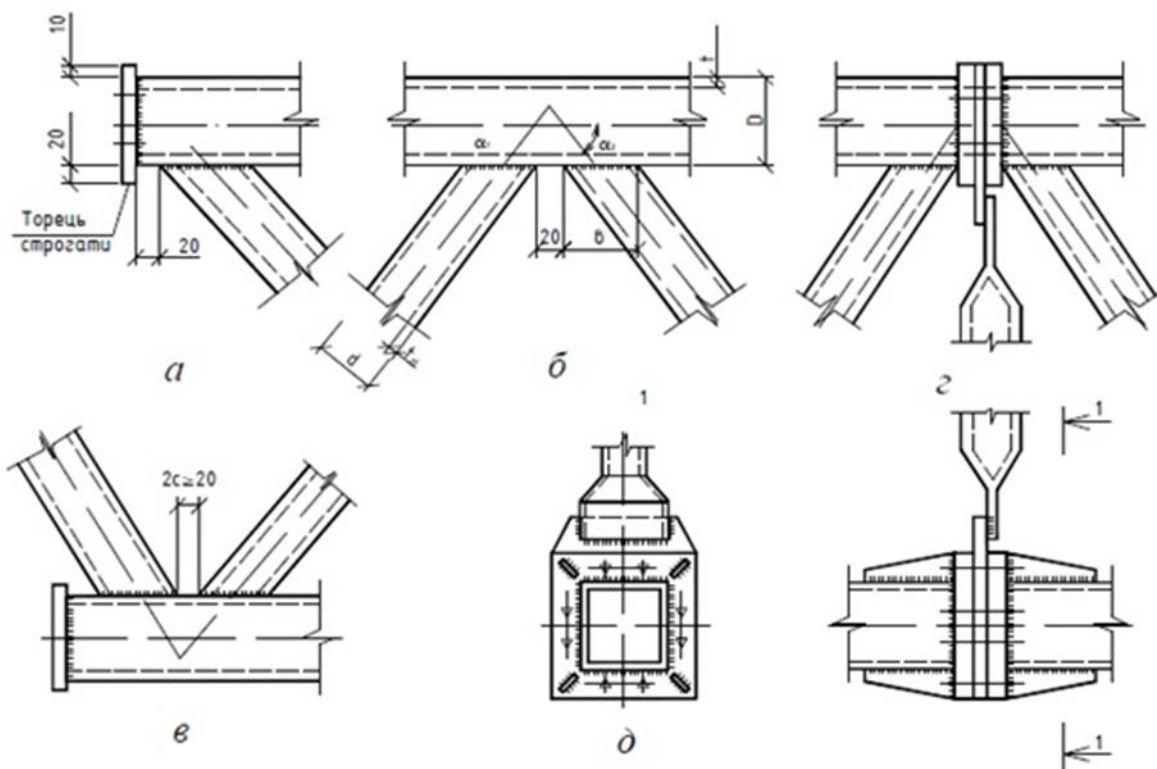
Вузли типової ферми із замкнутих гнутих профілів: а - опорний; б - верхнього поясу; в - нижнього поясу; г, д – монтажні
